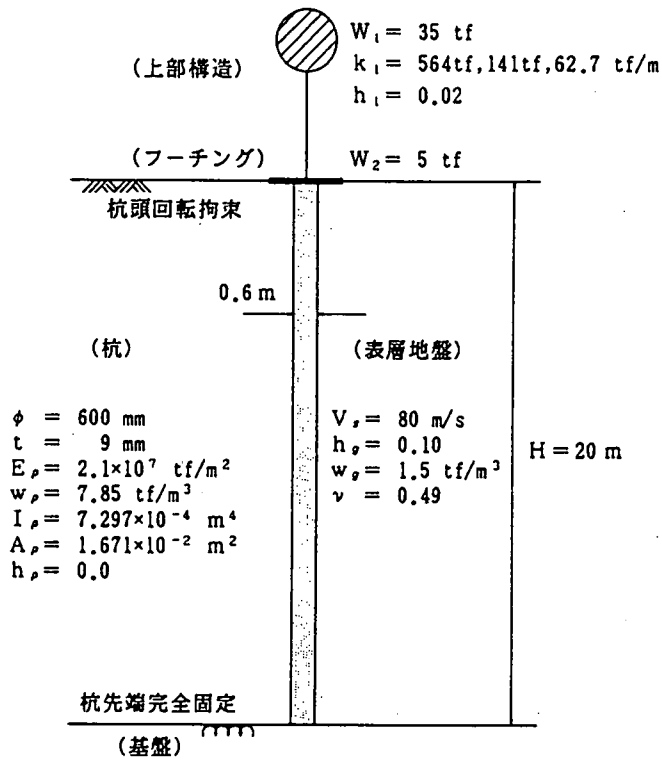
単杭基礎の構造モデル⁹⁾
